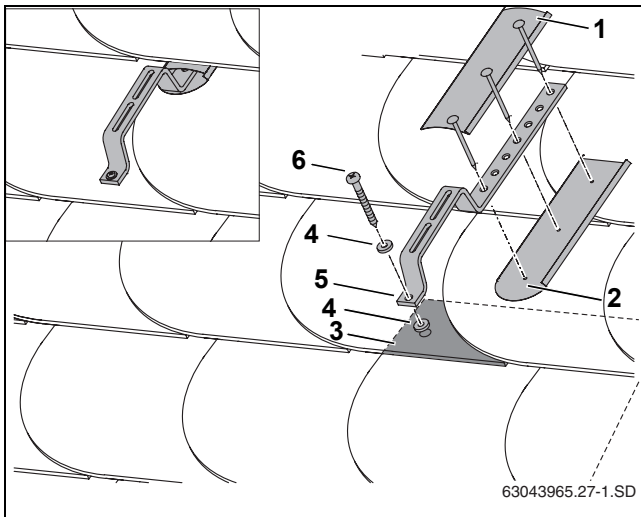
Montaje sobre cubierta de pizarra o chillas
